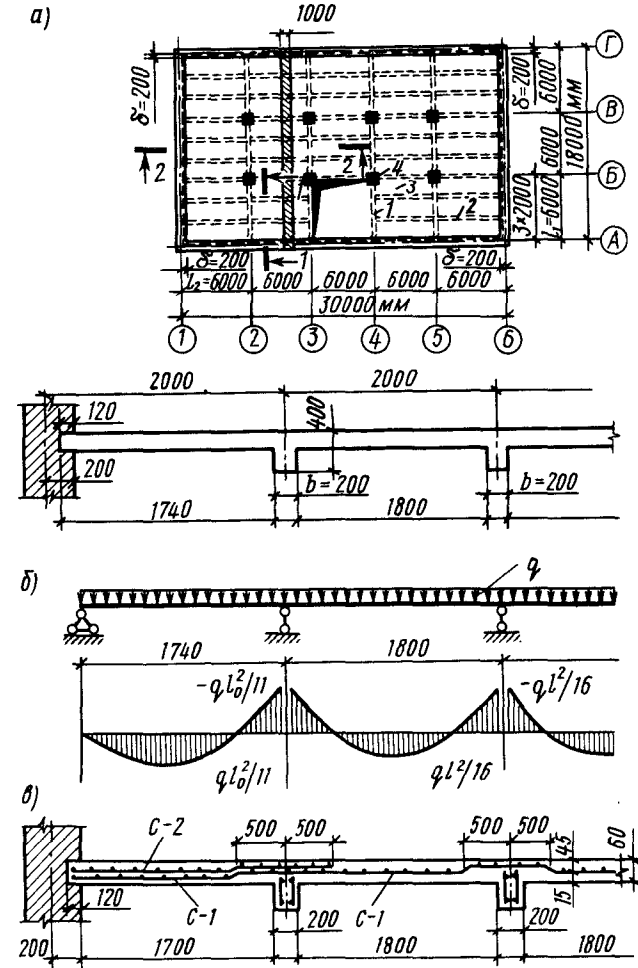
К расчету монолитного ребристого перекрытия с балочными плитами: а — компоновка конструктивной схемы перекрытия; б — конструктивная и расчетная схема плиты; в — армирование балочной плиты; 1 — главная балка; 2 — второстепенная балка, 3 — плита, 4 — колонна
